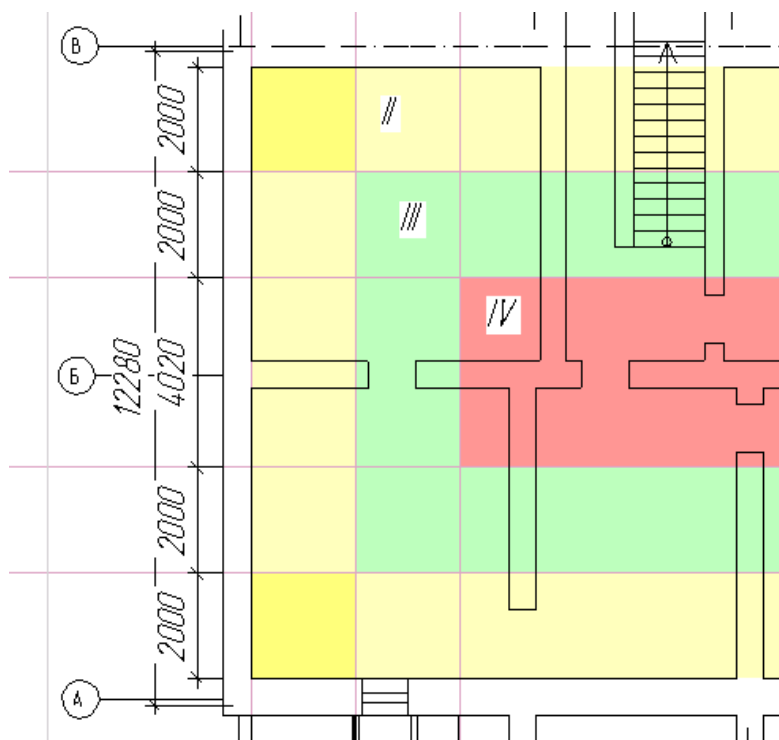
Теплотери через полы на грунте. План подвала, с нанесенными (с учетом стен по грунту) зонами;
